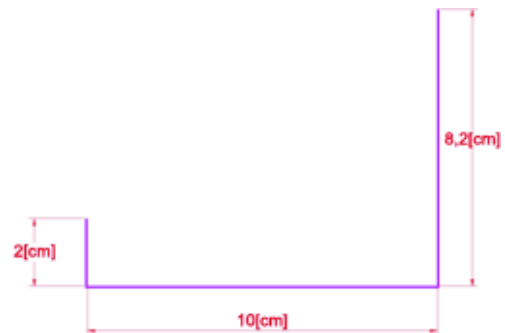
Dimensiones de las canaletas, Vista sección transversal.
